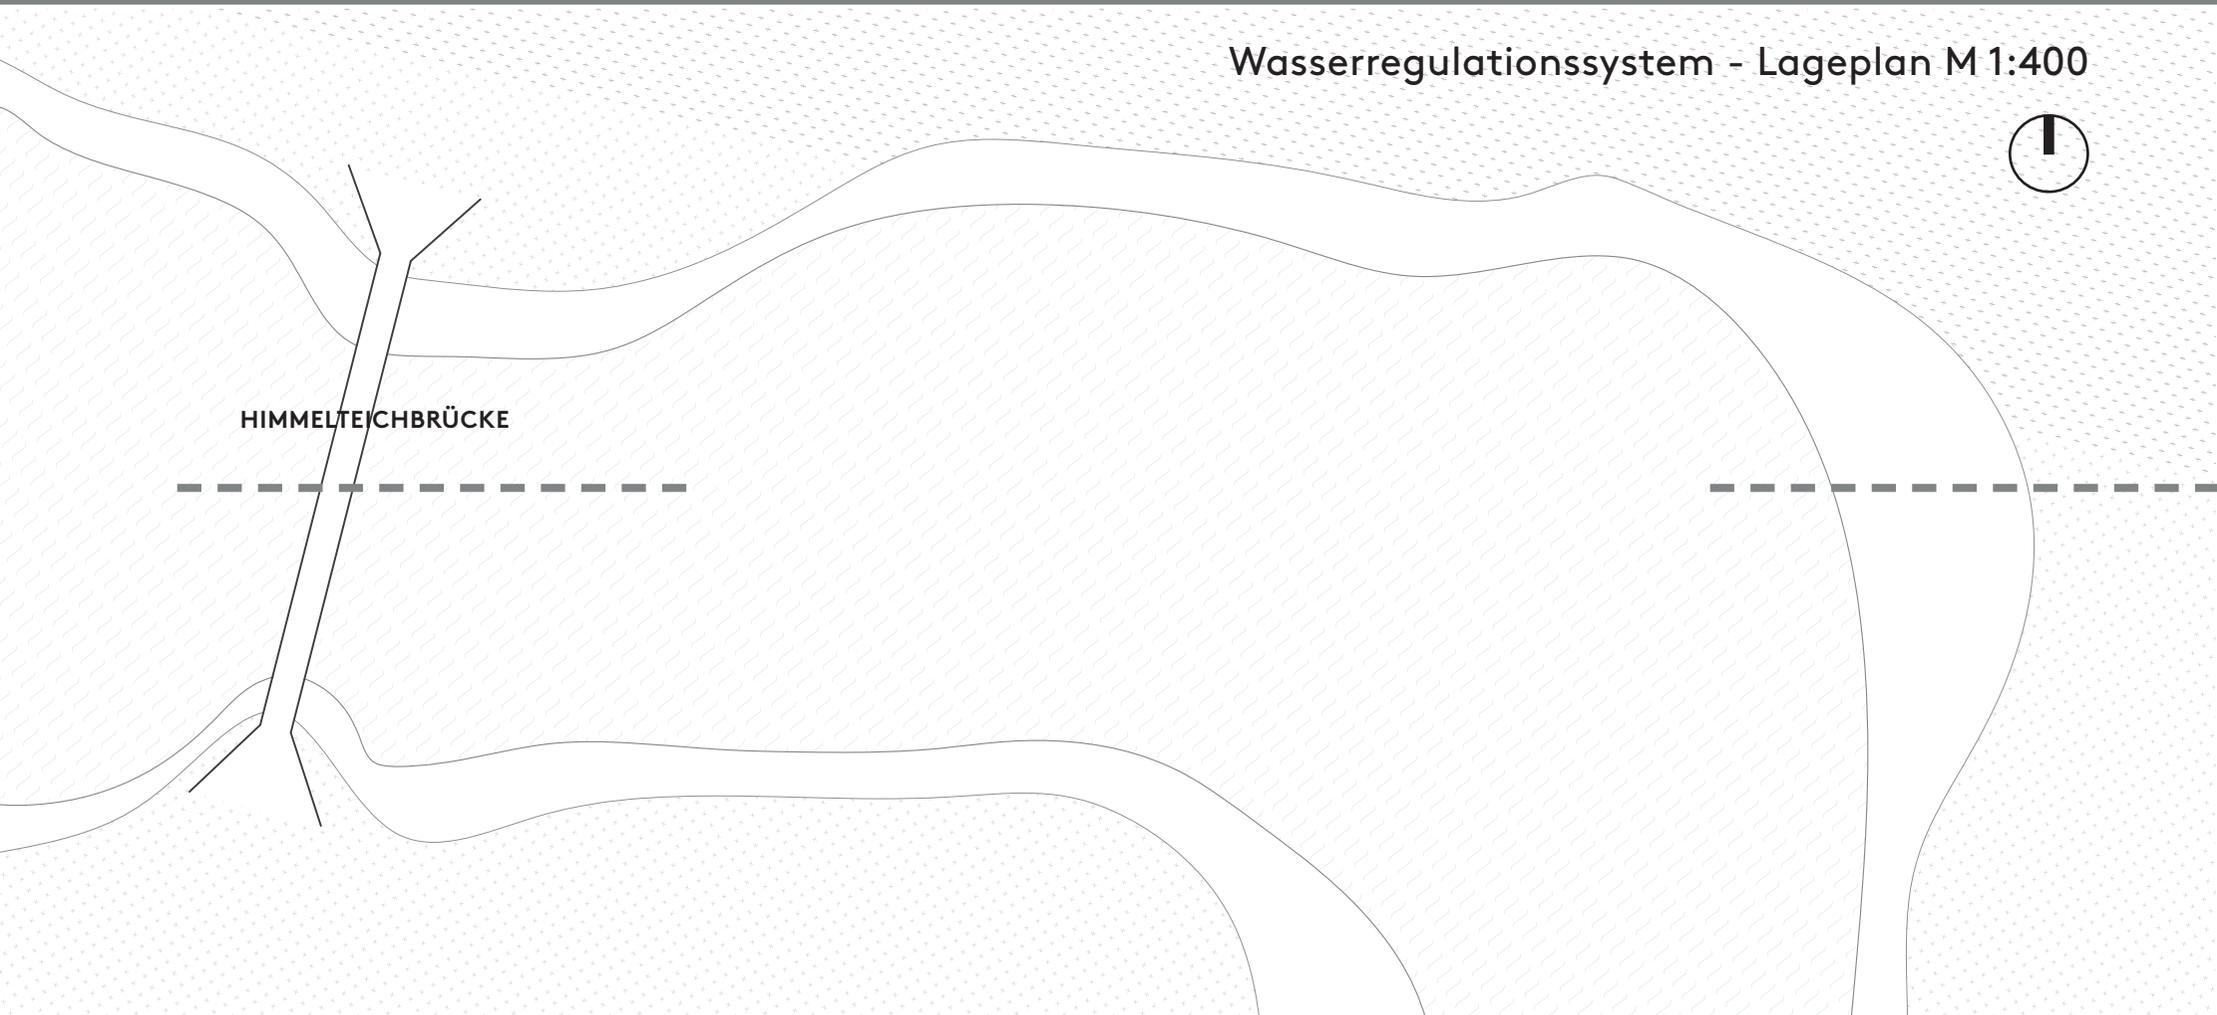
Himmelteich Lageplan M 1:400 (Táňa Kubiková 2017)
